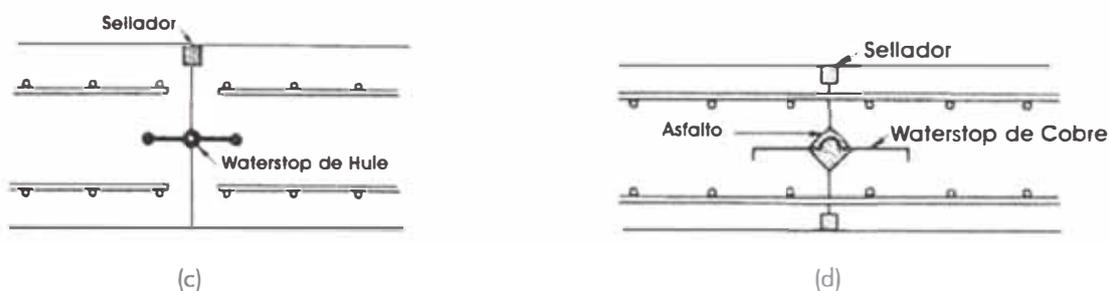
Detalles del diseño de juntas de contracción en estructuras de C°A°
